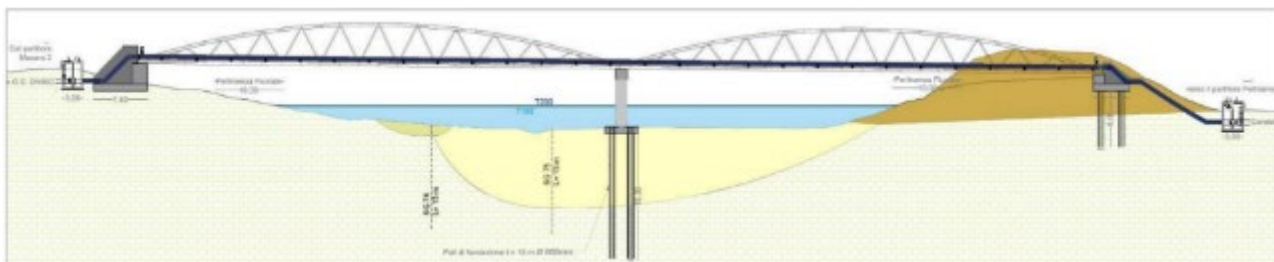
Attraversamento del Fiume Mâzaro - Estratto dalla sezione geologica e geotecnica di progetto
